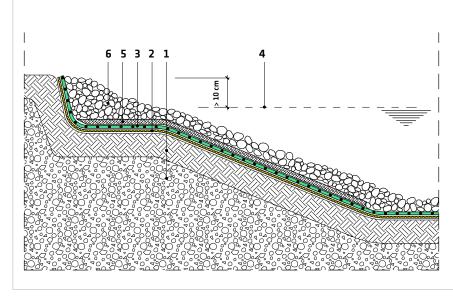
| Randabschluss mit Sikaplan® W Flachprofilstahl V4A
